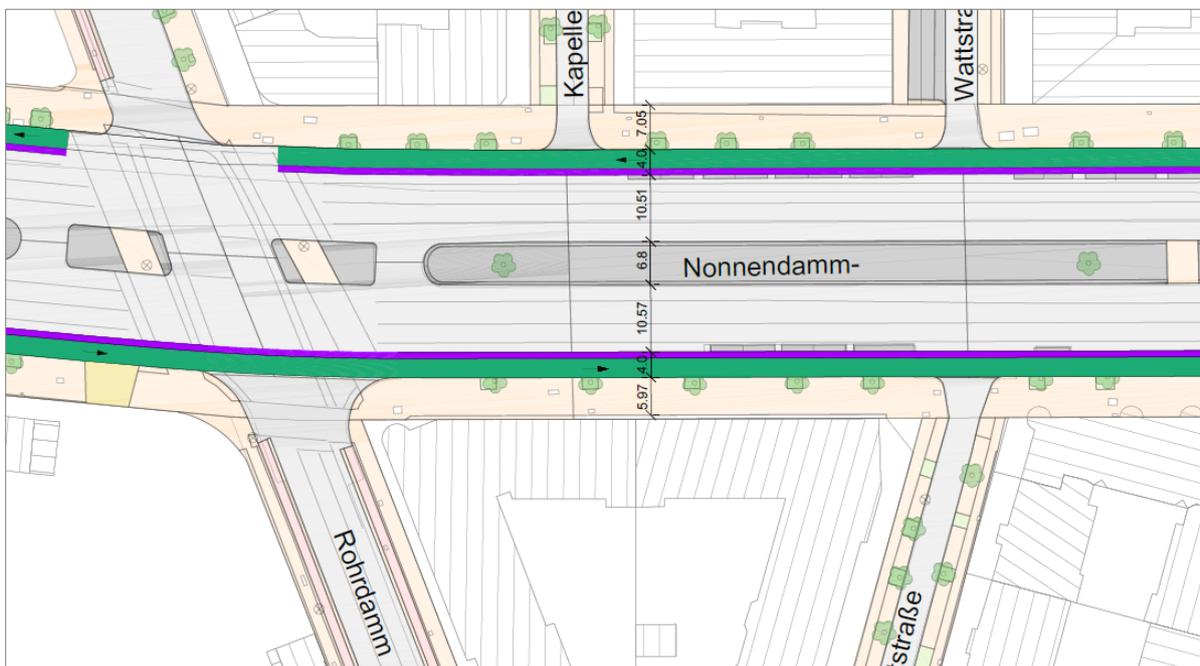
Nonnendammallee – Rohrdamm, Ausschnitt Lageplan
